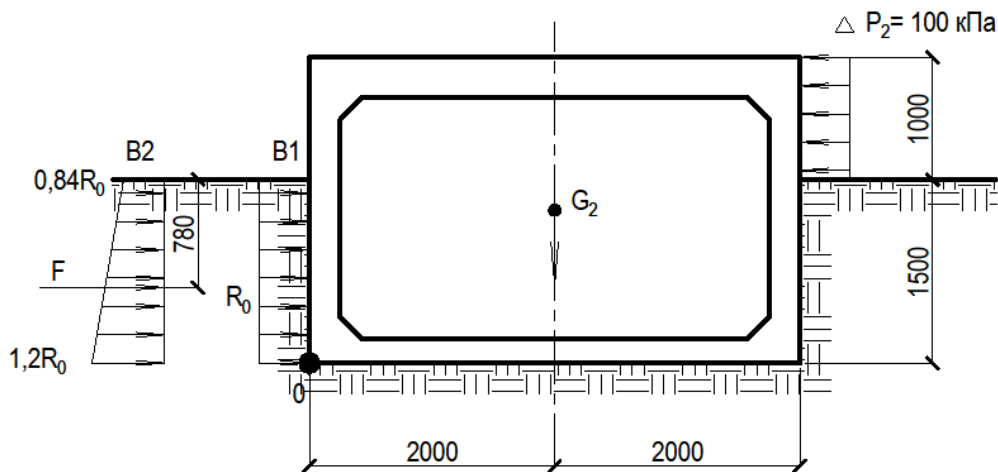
Розрахункова схема заглибленого а) базування сховища «Варта-2»
